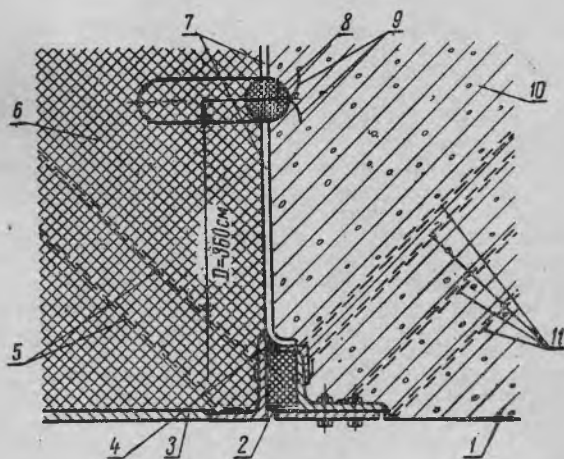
Стык соединения стального и железобетонного монолитного напорных трубопроводов:
